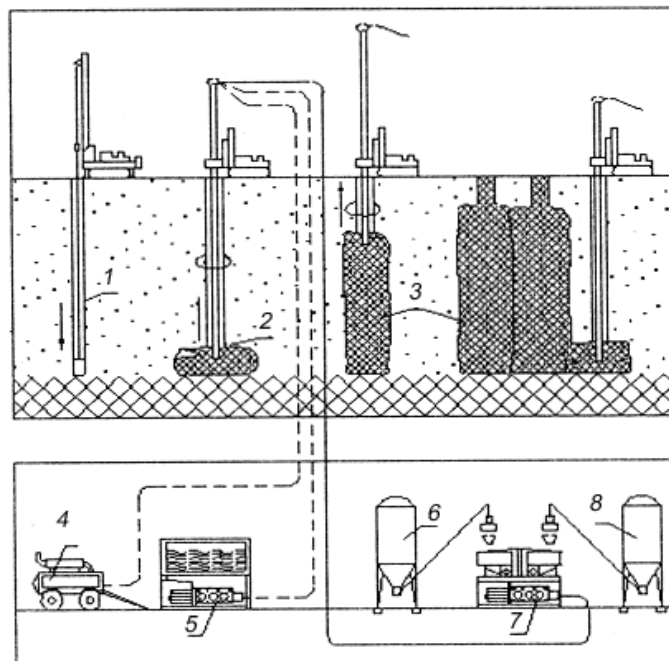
Схема обладнання стінки із паль з використанням струмінної технології (jet grouting): 1 – свердловина до щільних ґрунтів; 2 – ін'єктор; 3 – формована паля; 4 – компресор; 5 – насос для подачі води; 6 – ємності цементу і піску; 7 – розчинонасос
